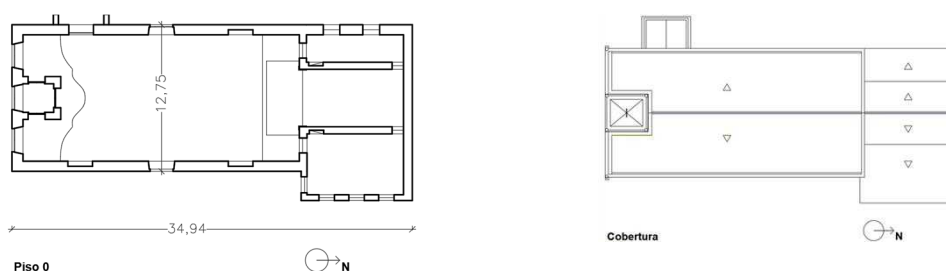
Planta do piso térreo e da cobertura (dimensões em metros).
